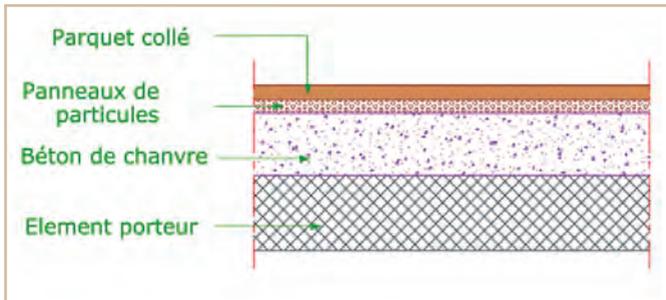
Schéma simplifié de parquet collé sur panneaux sur forme de béton de chanvre
